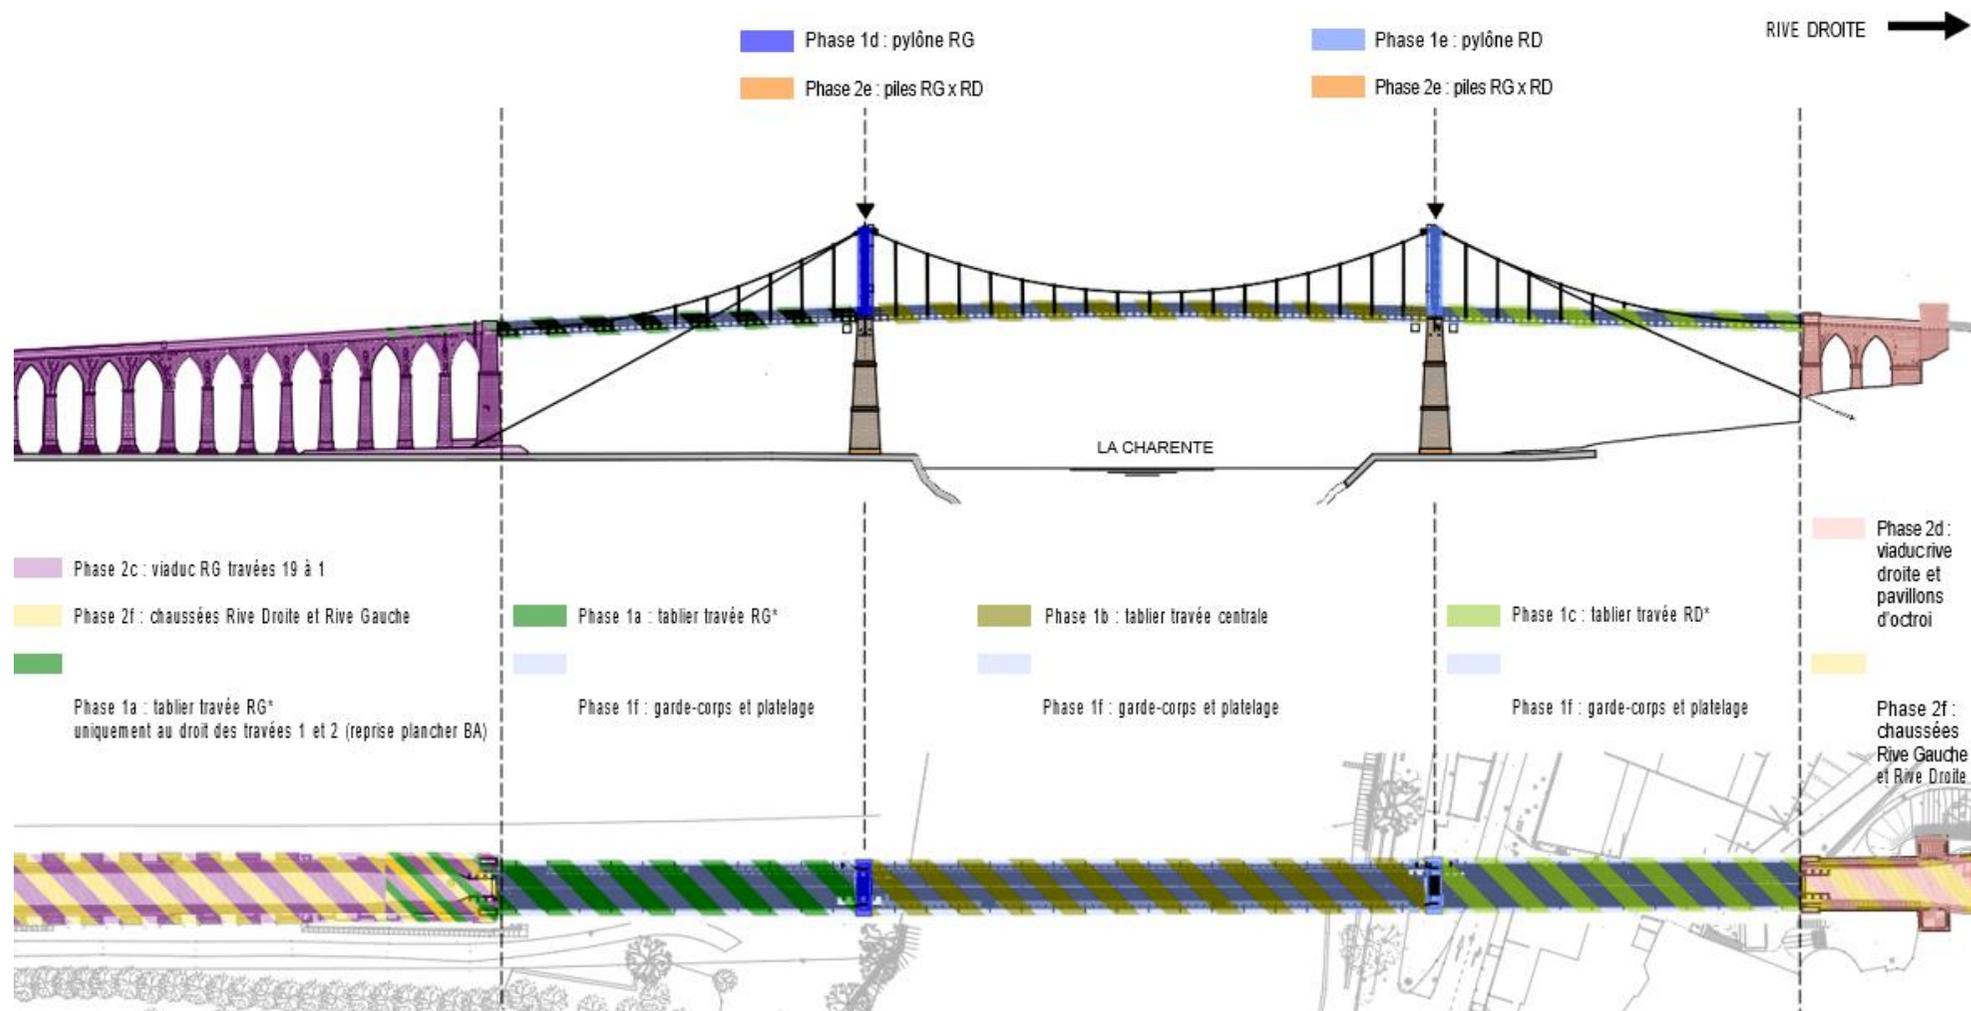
Phase du planning des travaux sur plan – rive gauche et droite
